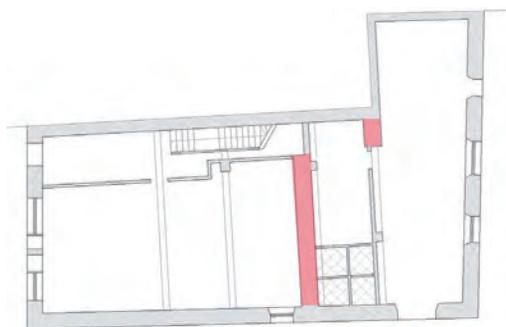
14. KALE NAGUSIA 32, PLANTA BAJA
